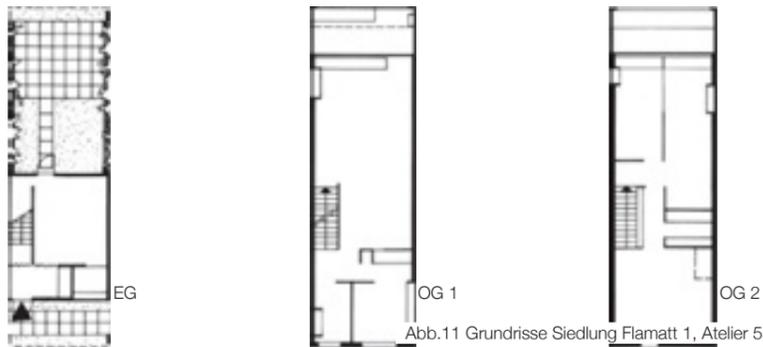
Grundrisse Siedlung Flamatt 1, Atelier 5
